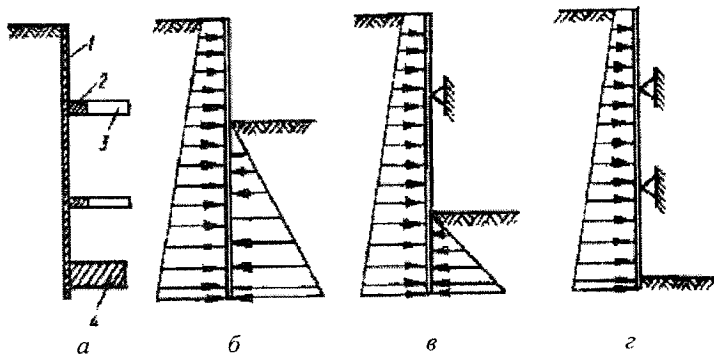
Розрахункова схема споруди зі стінами з проміжними опорами:
